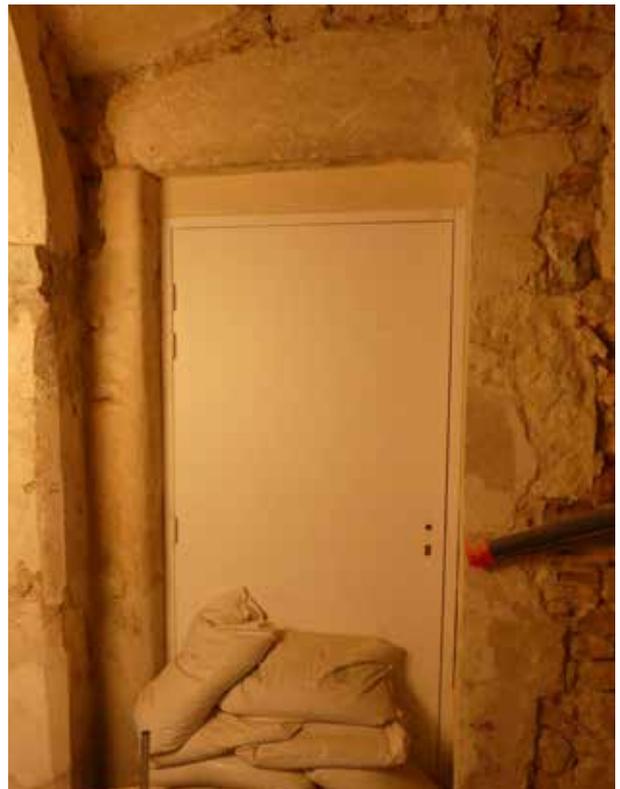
La cloison MR1011 au rez-de-chaussée et sa porte 1120 entre le passage d'entrée 0-1, au premier plan, et une pièce hors emprise à l'arrière. On note la parfaite intégration de l'encadrement de la porte dans la maçonnerie du mur et la reprise, approximativement au niveau du linteau, du sommet du mur pour la mise en place de la voûte VT1046
